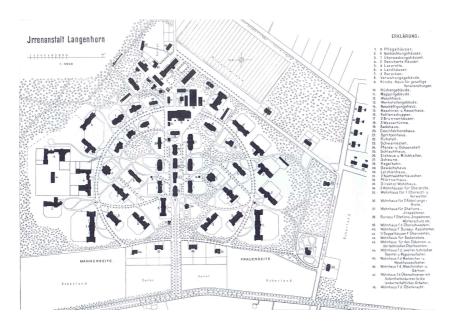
Grundriss der Staatskrankenanstalt Langenhorn (Neuberger 1910: 129)
